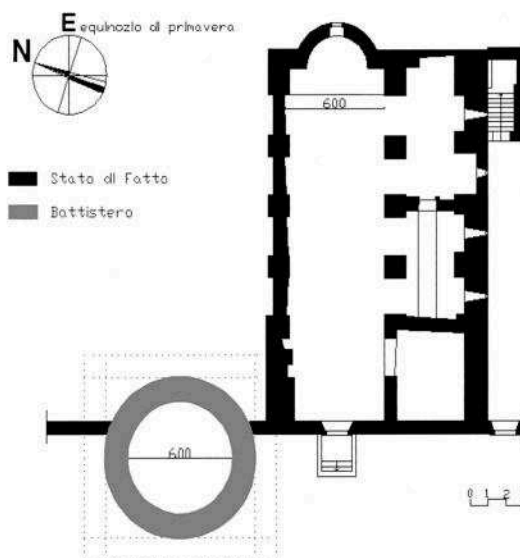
San Foca. Pianta dello stato di fatto e restituzione planimetrica della struttura circolare (INTRIVICI 2007).
